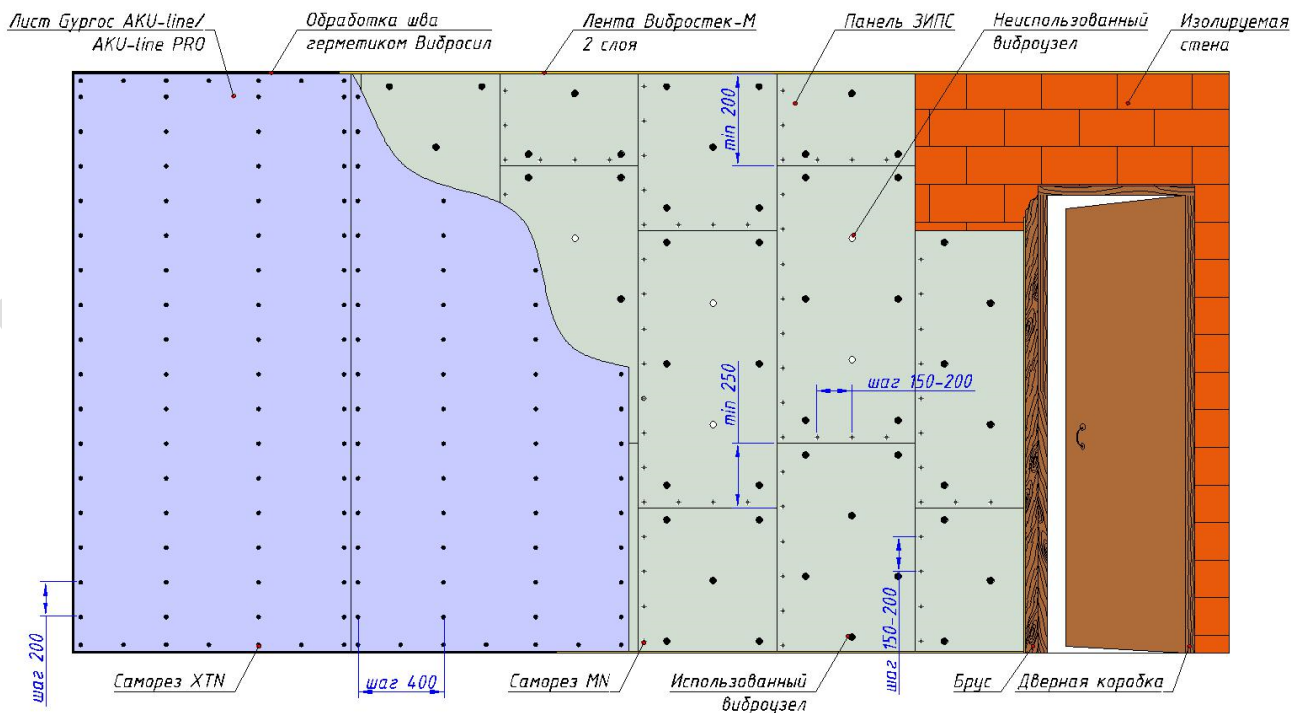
Схема монтажа бескаркасной системы ЗИПС.
